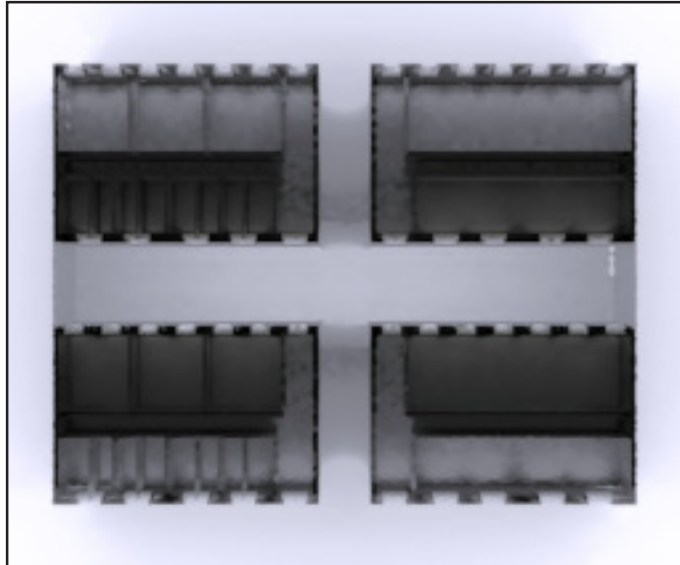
Erdgeschoß; Gebäudeabstand 5.55m
